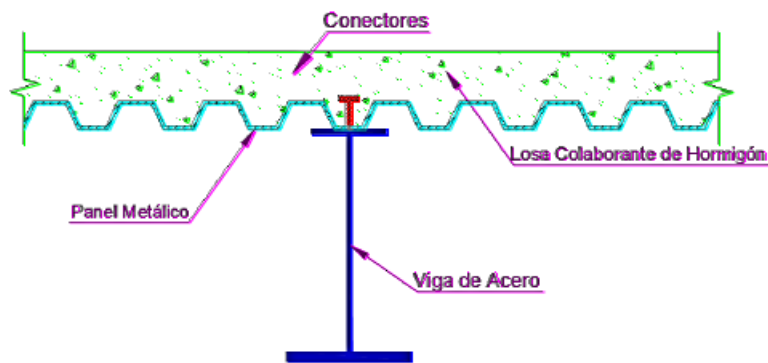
Viga Compuesta con Losa de hormigón sobre panel metálico
